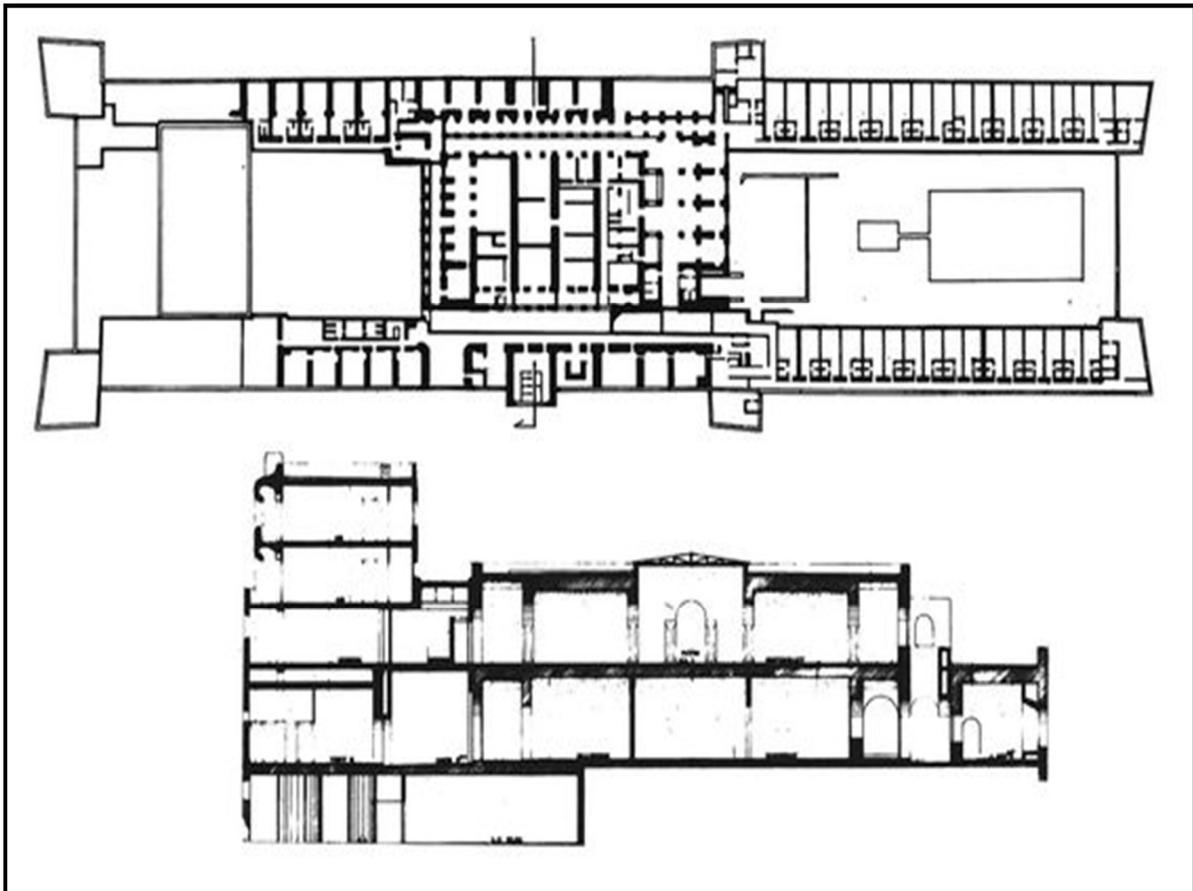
Plan et Coupe de l'Hotel de M'zab
